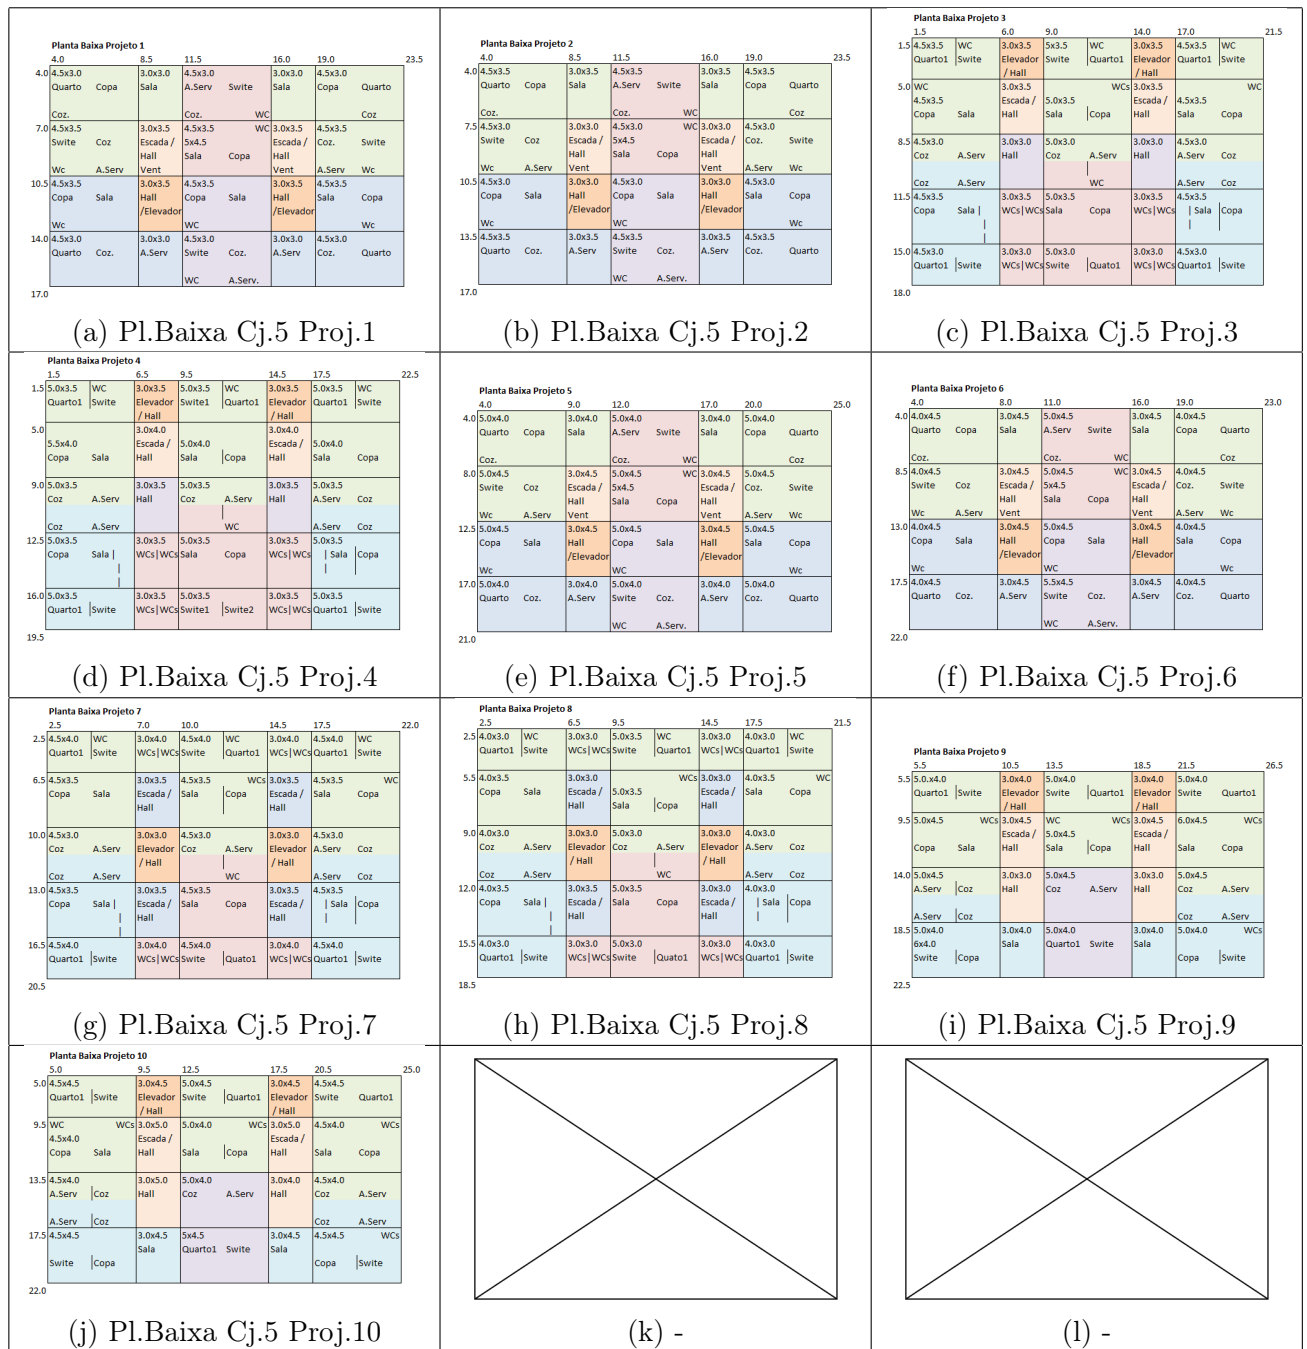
Plantas Baixas - Cjs.5 e 6 - Pjs.Treino 1 a 7 - Teste 8 a 10
